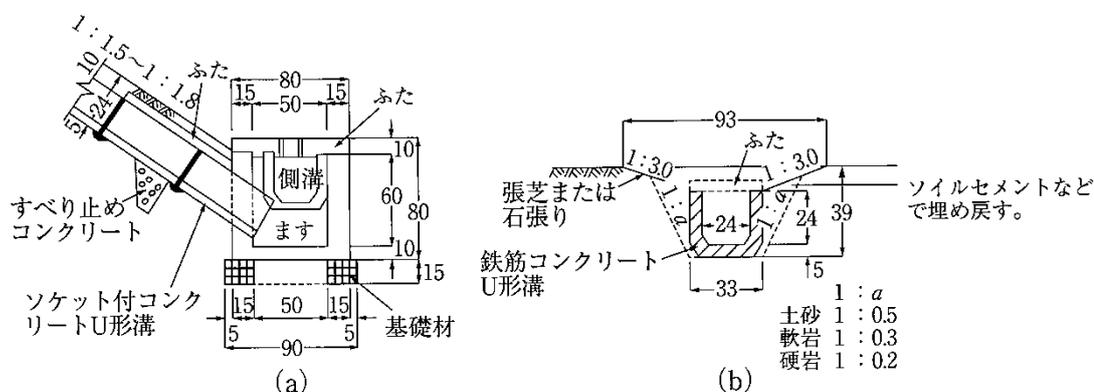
鉄筋コンクリート U 型溝による縦排水溝の設置例(単位:cm)
